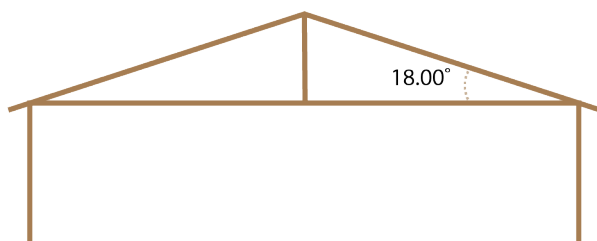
visar minsta tillåtna takvinkel enligt planförslaget.
